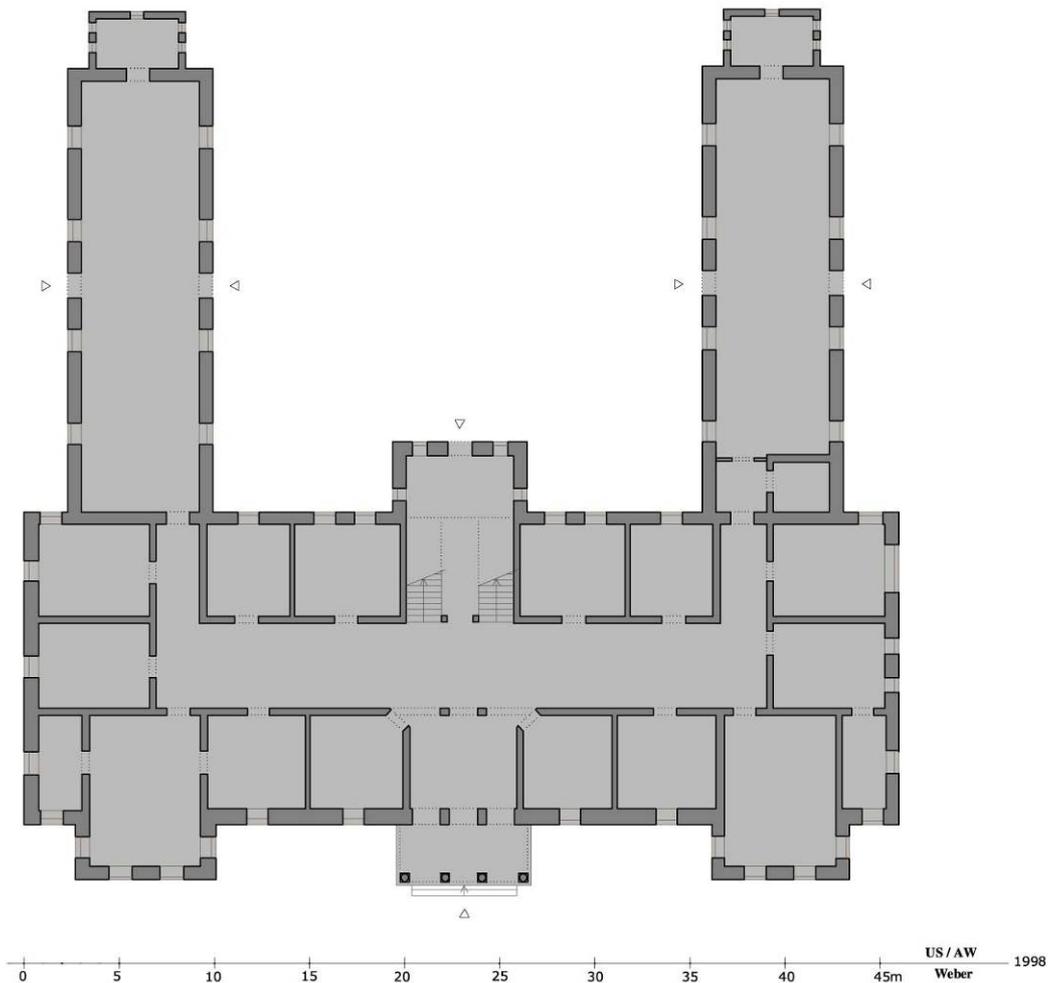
Krankenhaus al-Ğurabā, Grundriss EG
